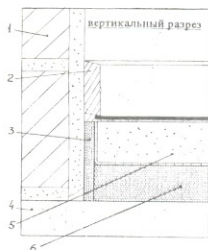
Звукоизоляция внутренних межэтажных перекрытий
